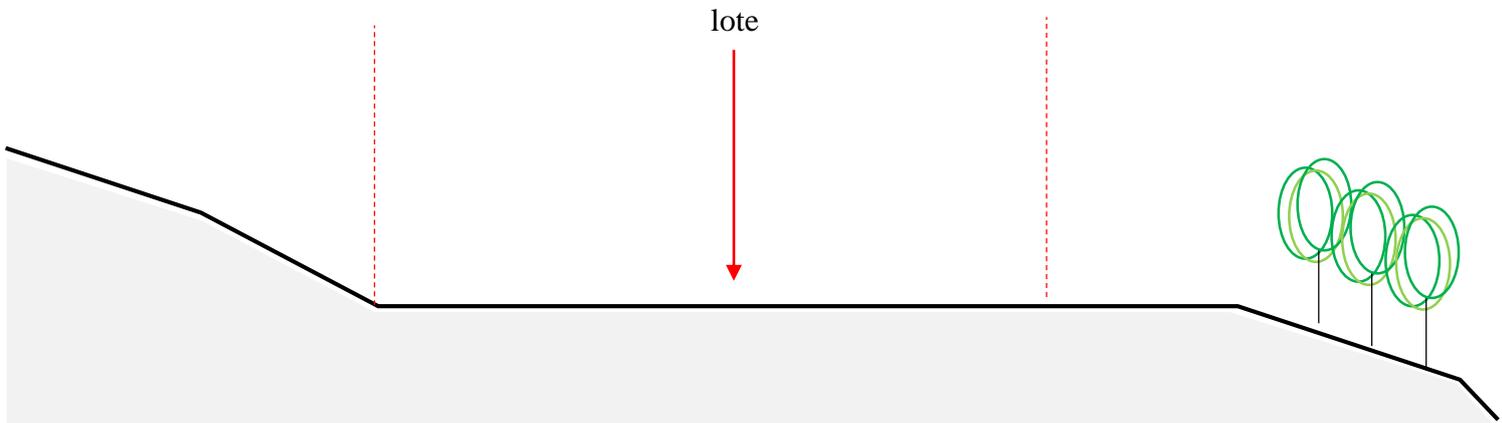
Corte topográfico lote de trabajo. Fuente: Elaboración propia
